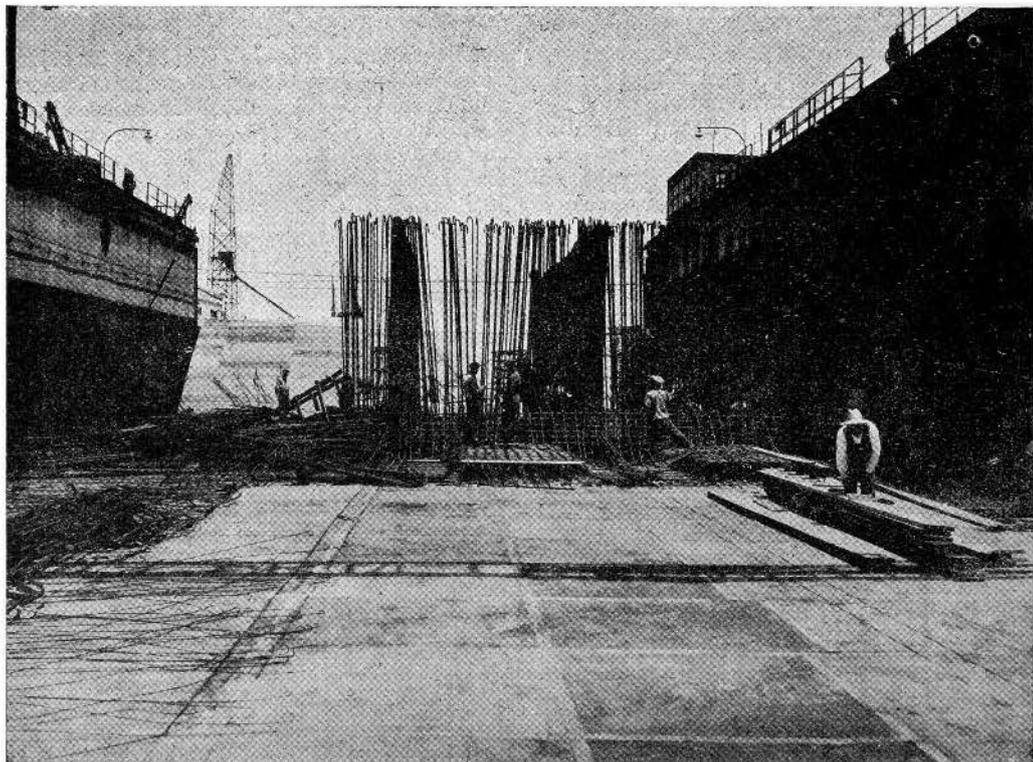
Montaje de la armadura de uno de los grandes cajones sobre el plan del dique flotante ya preparado para el encofrado del fondo
